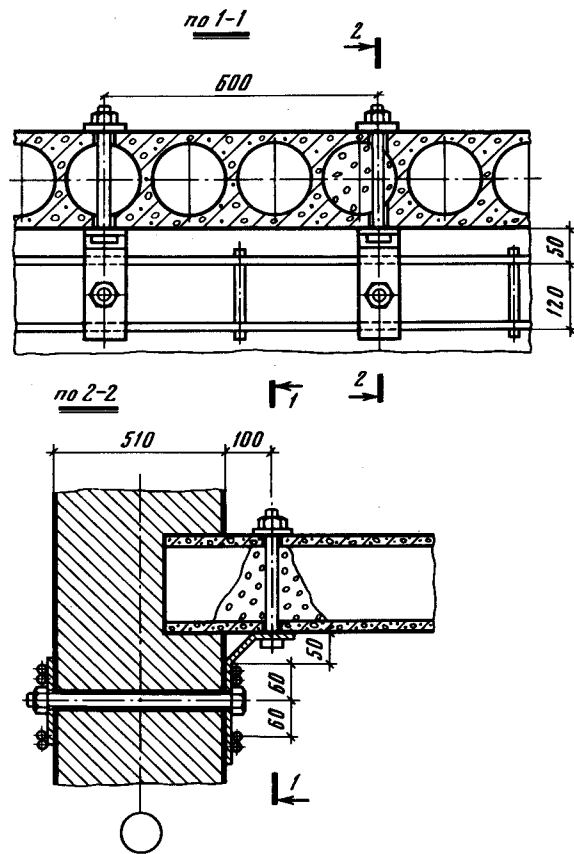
Конструкция крепления гибкого металлического пояса к перекрытию и стенам здания
